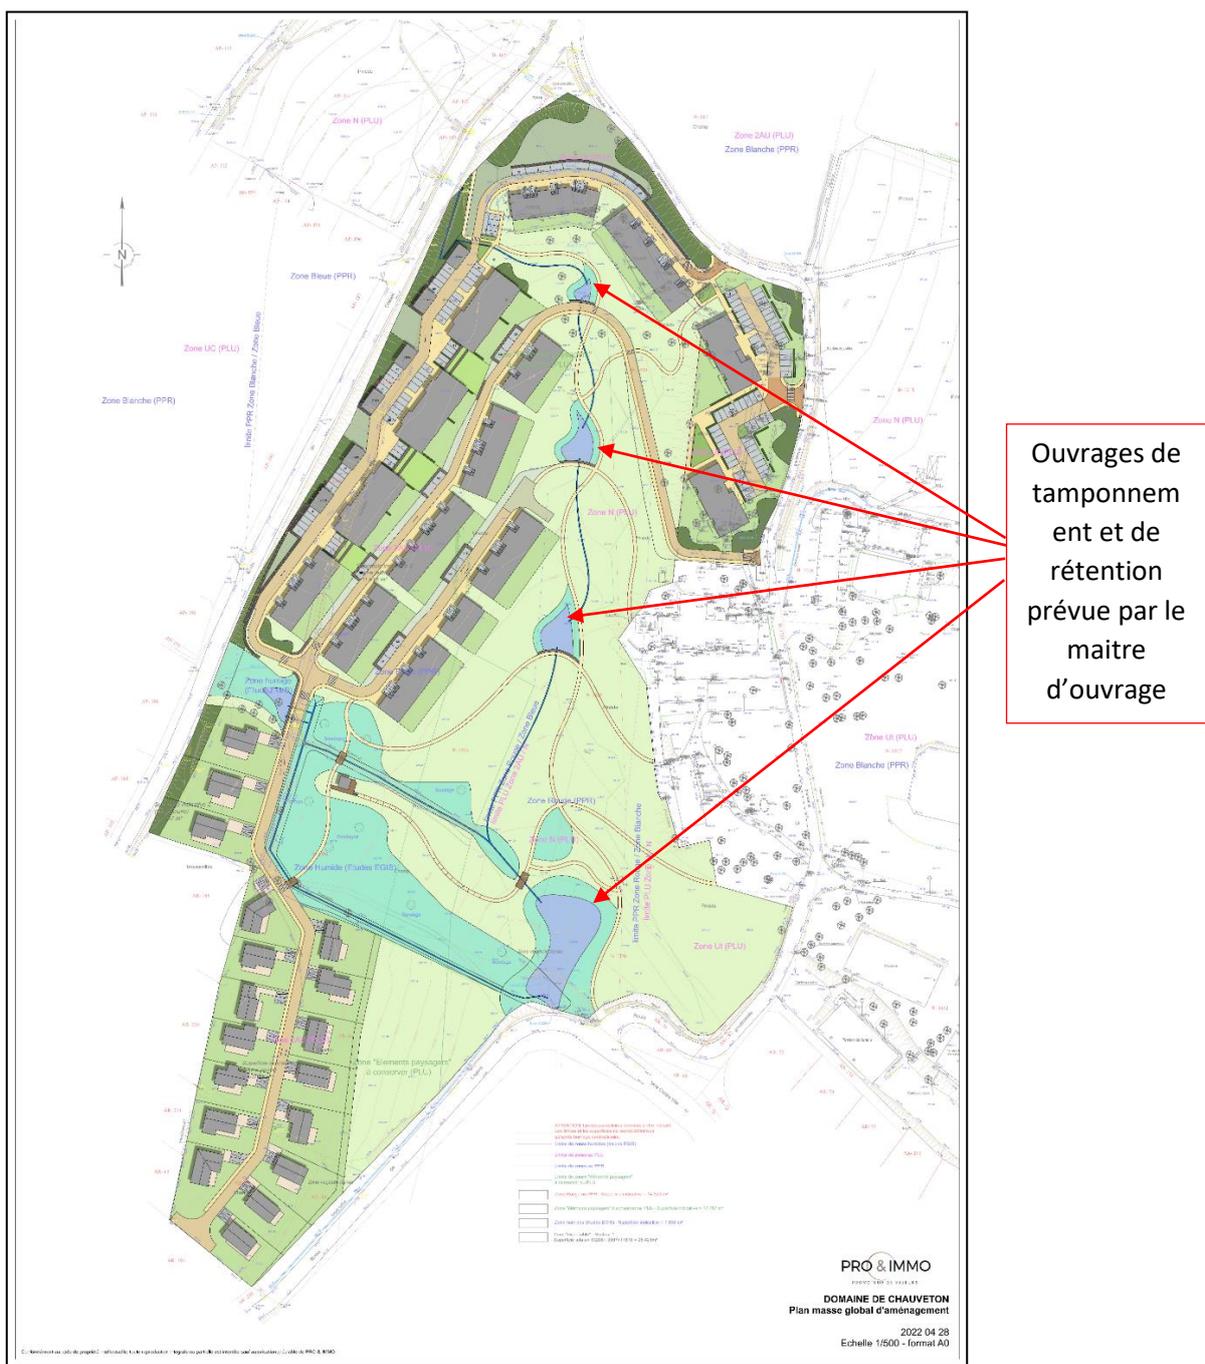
ouvrage envisagé par le Maitre d'Ouvrage (plan de masse transmis)
